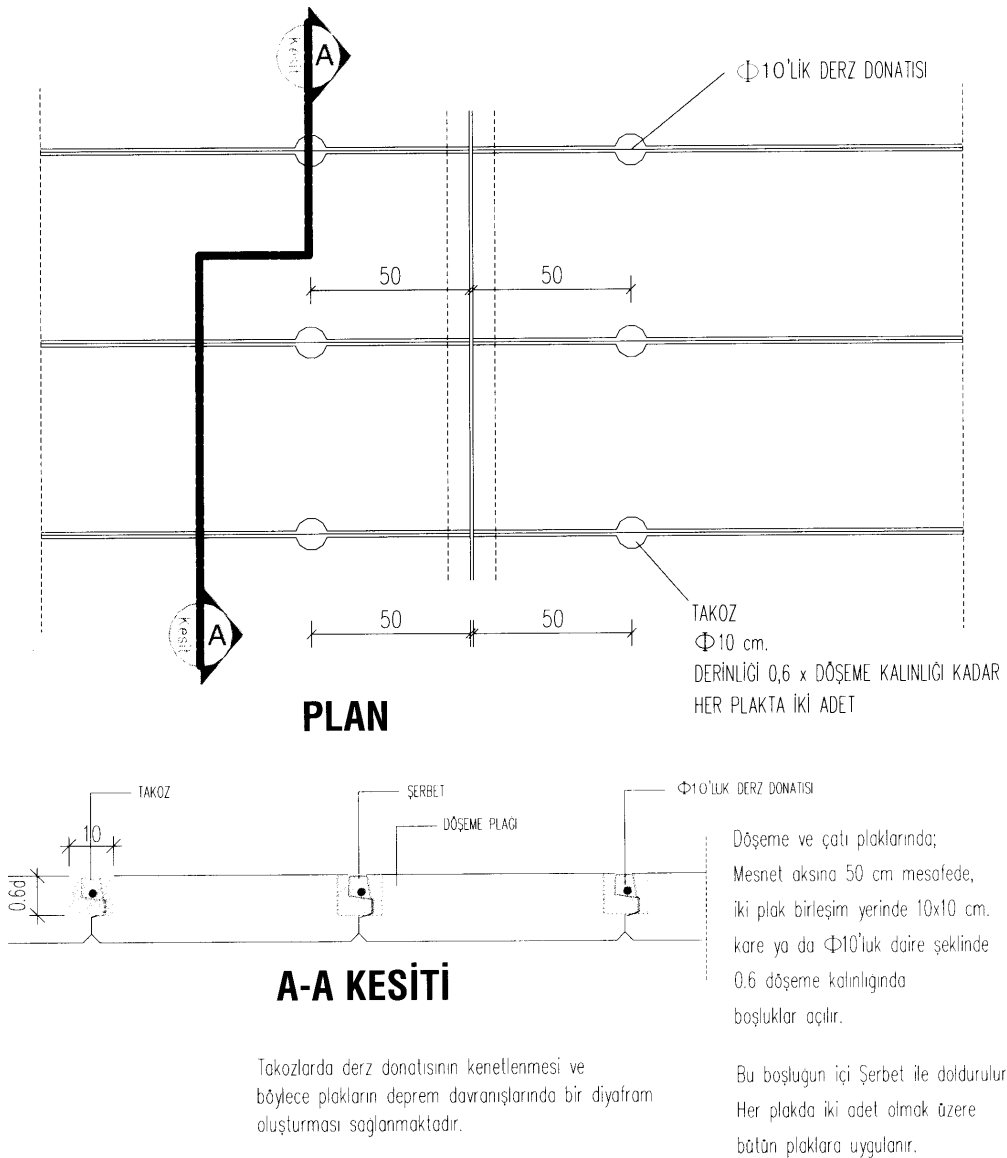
YPK Sistemi Çatı Elemanları Montaj Planı [18]
